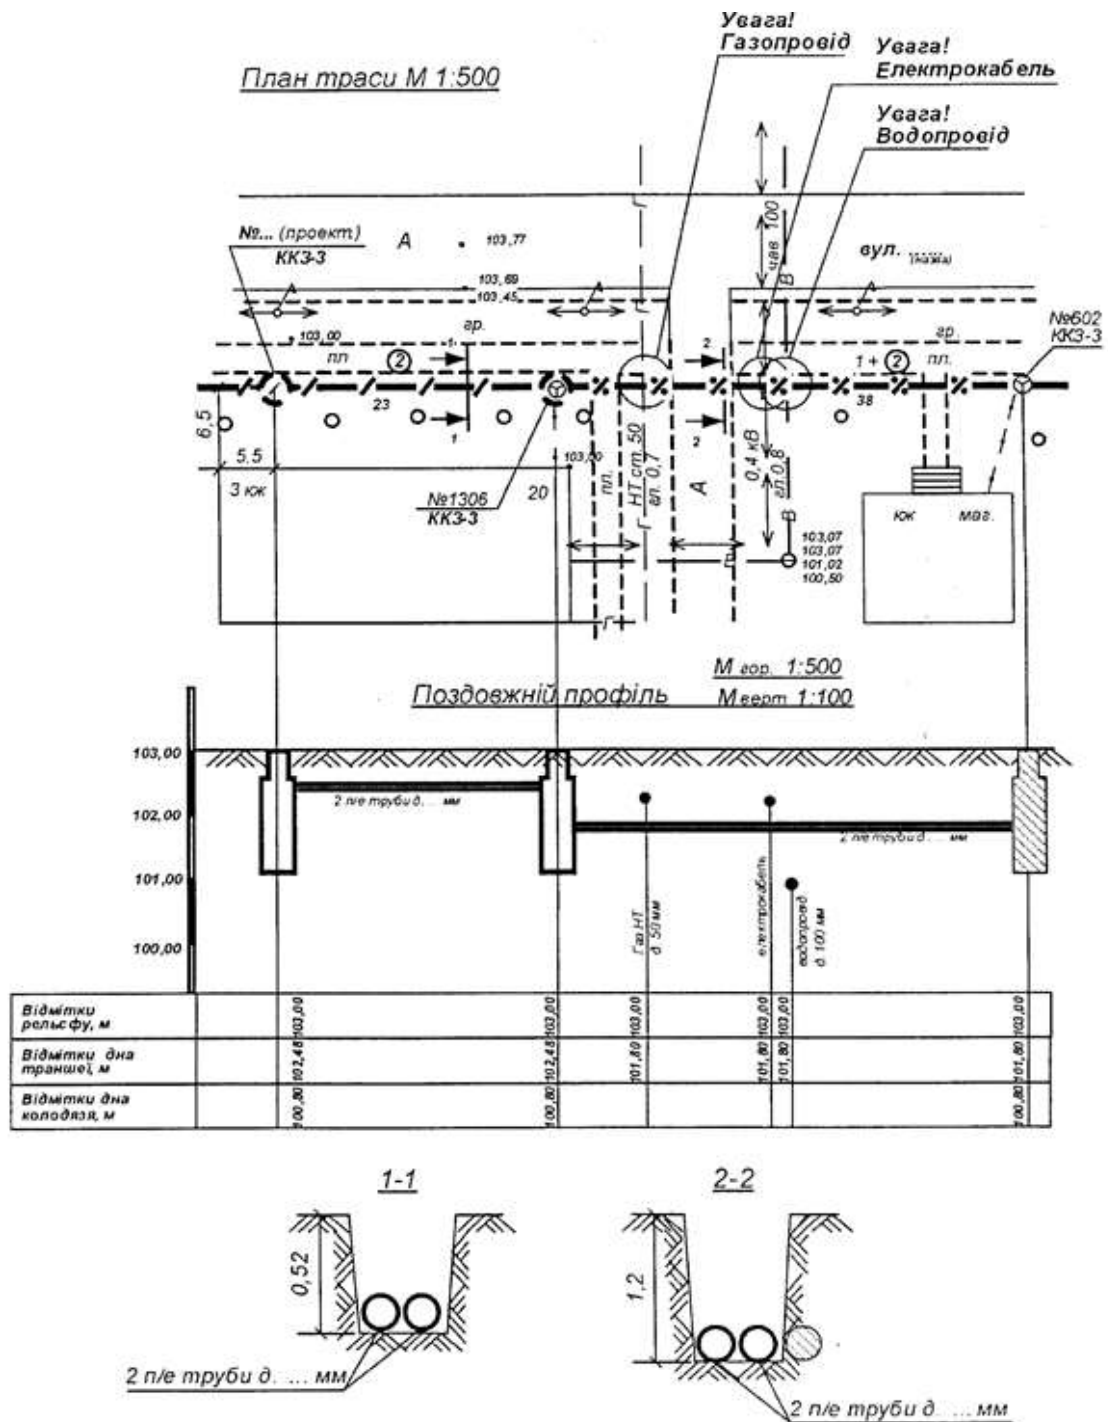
План траси будівництва (докладання) кабельної каналізації
